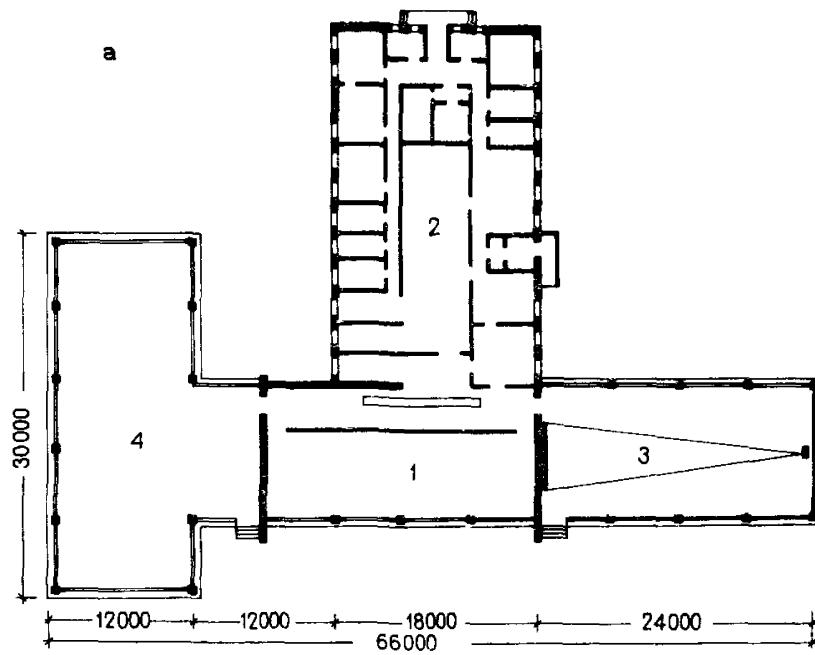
Примеры универсального использования зальных помещений и открытых площадок
